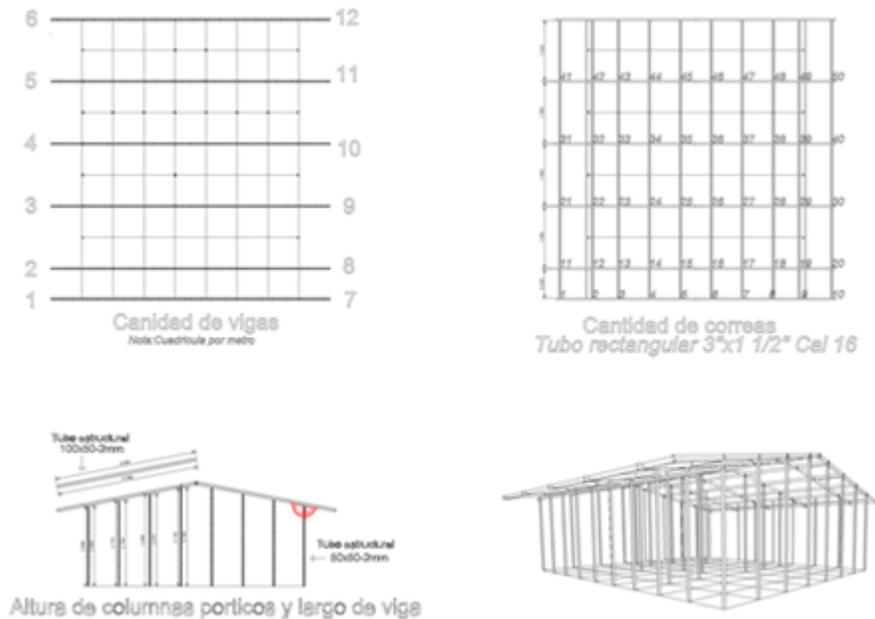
Planos Estructurales Cubierta. Elaborado Por la Empresa Meisa Sas. Fuente: Intera Sas
